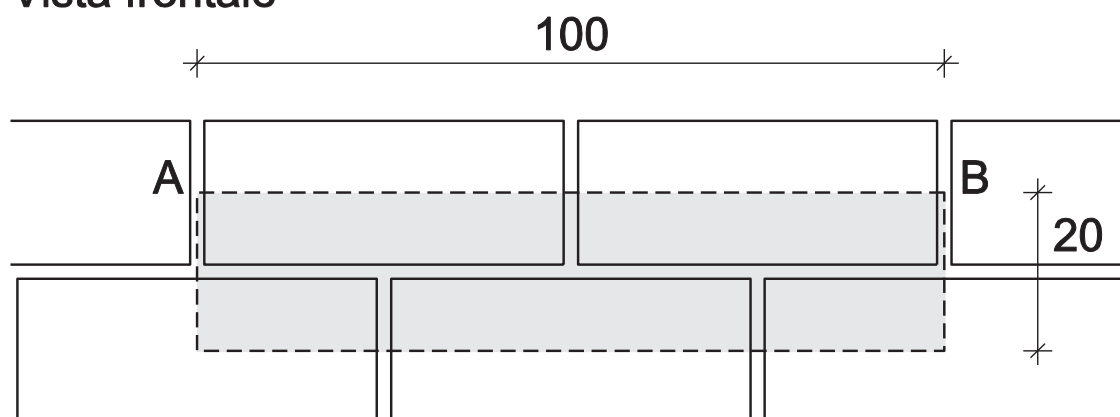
Porzione di muro oggetto dell'analisi tridimensionale ad elementi finiti.
